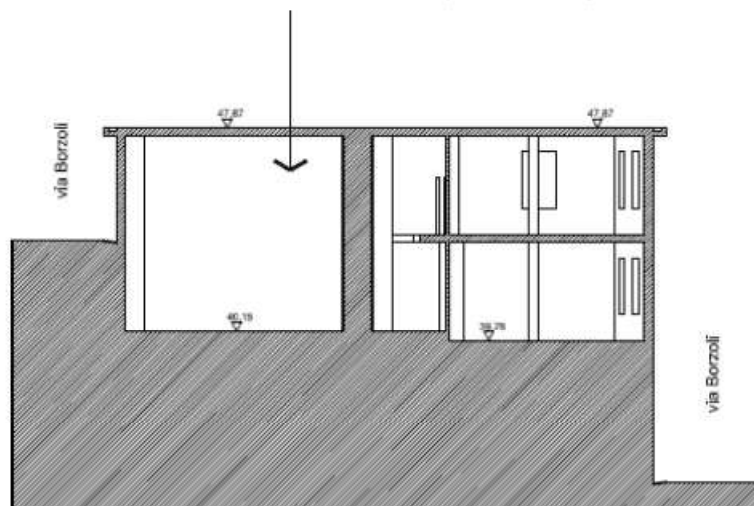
Sezione longitudinale cantiere in fase 2 (edificio M1)
